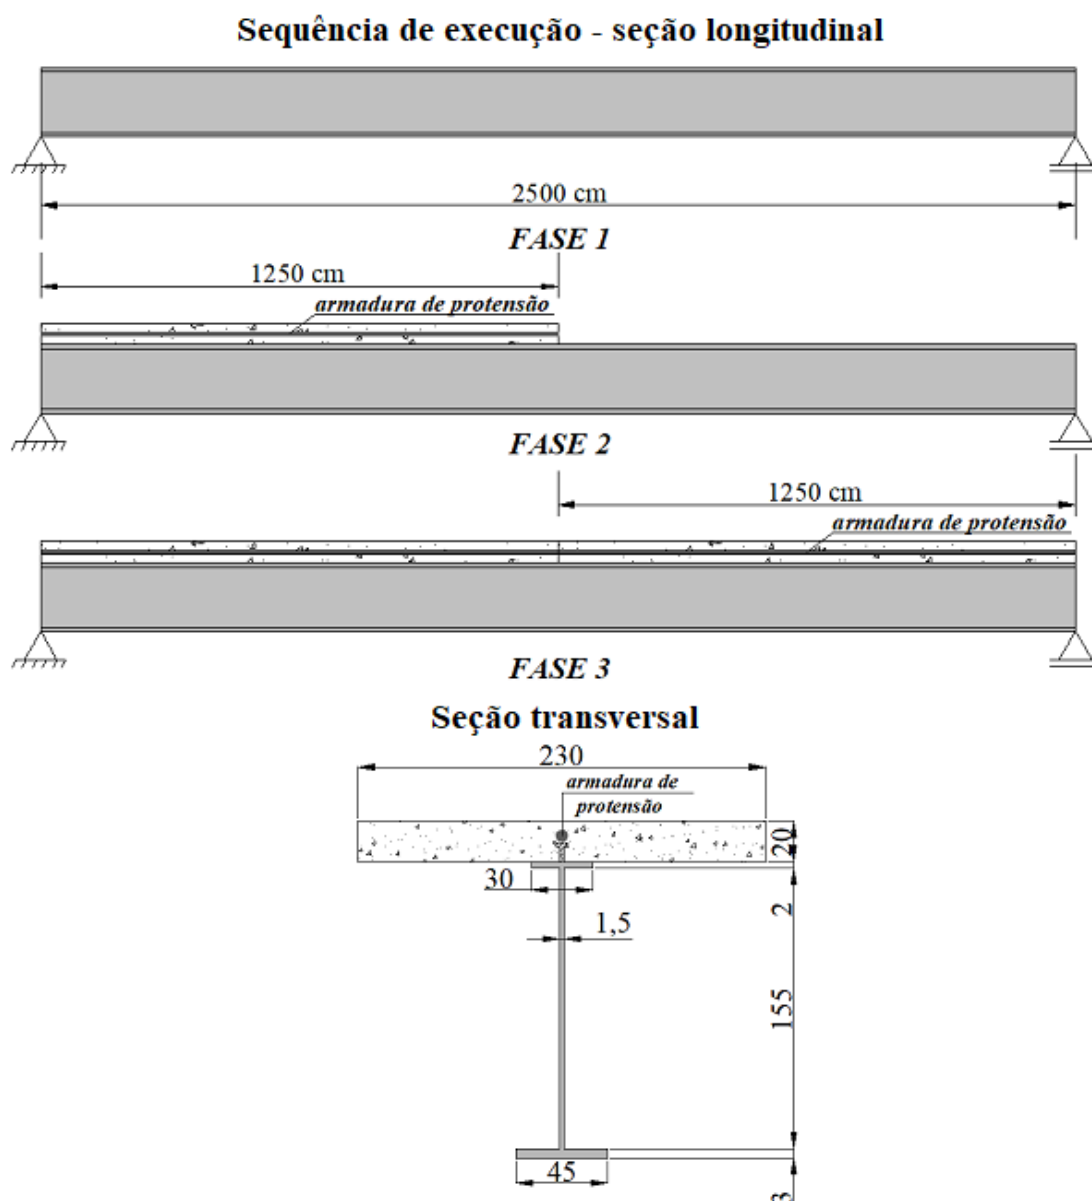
Detalhes da seção e execução da viga mista protendida (unidade em cm).
